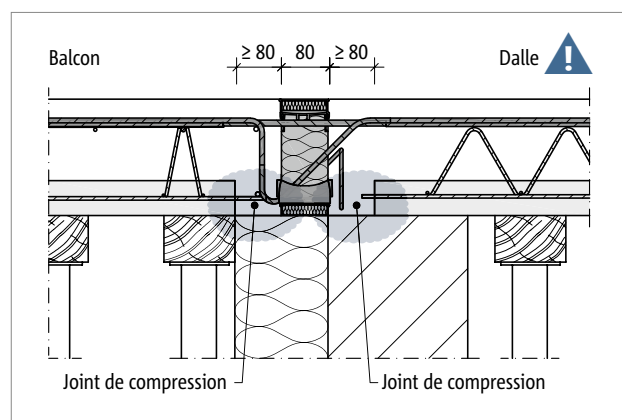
Schöck Isokorb® T types K-E, K-T : montage dans plancher en prédalles avec support mural
